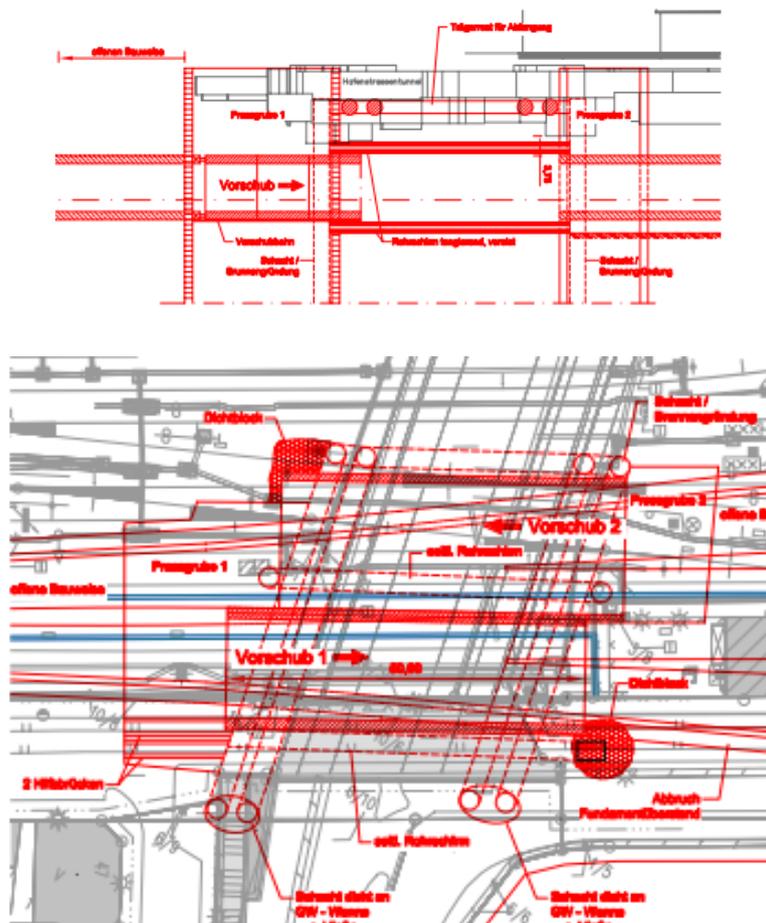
Lageplanausschnitt und Längsschnitt Hafentunnel Typ B
